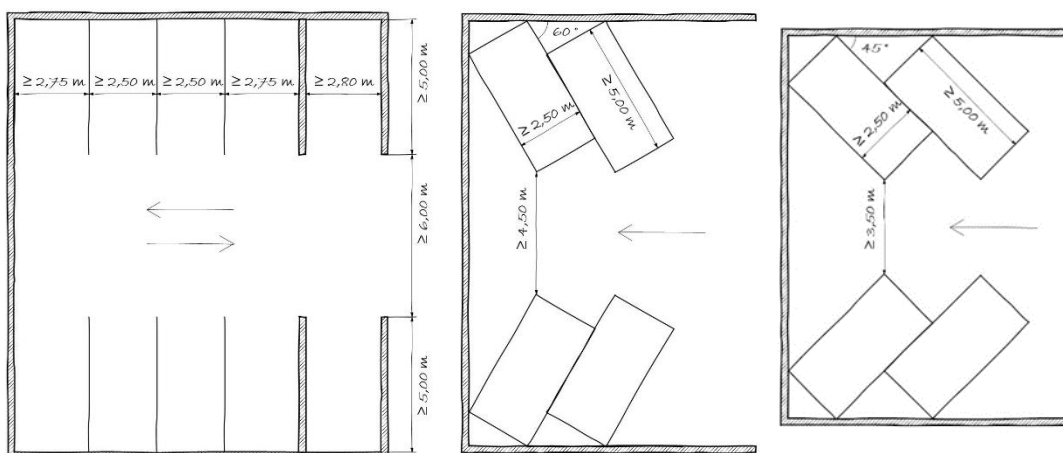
Dimensionnement des emplacements de stationnement pour voitures
